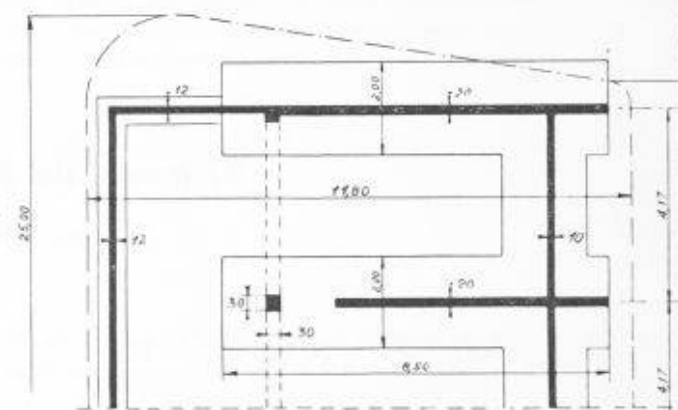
Plan partiel, coupe. (Ech. 1 : 150.)
